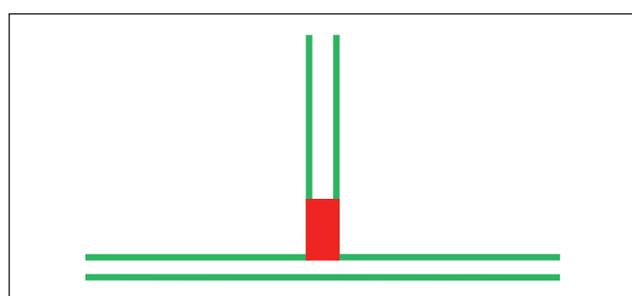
25 cm Stahlbetontrennwand auf einer 35 cm Betondecke. Die Trennwand ist auf einer Polystyrol-Wärmedämmung gelagert (Vertikalschnitt).
